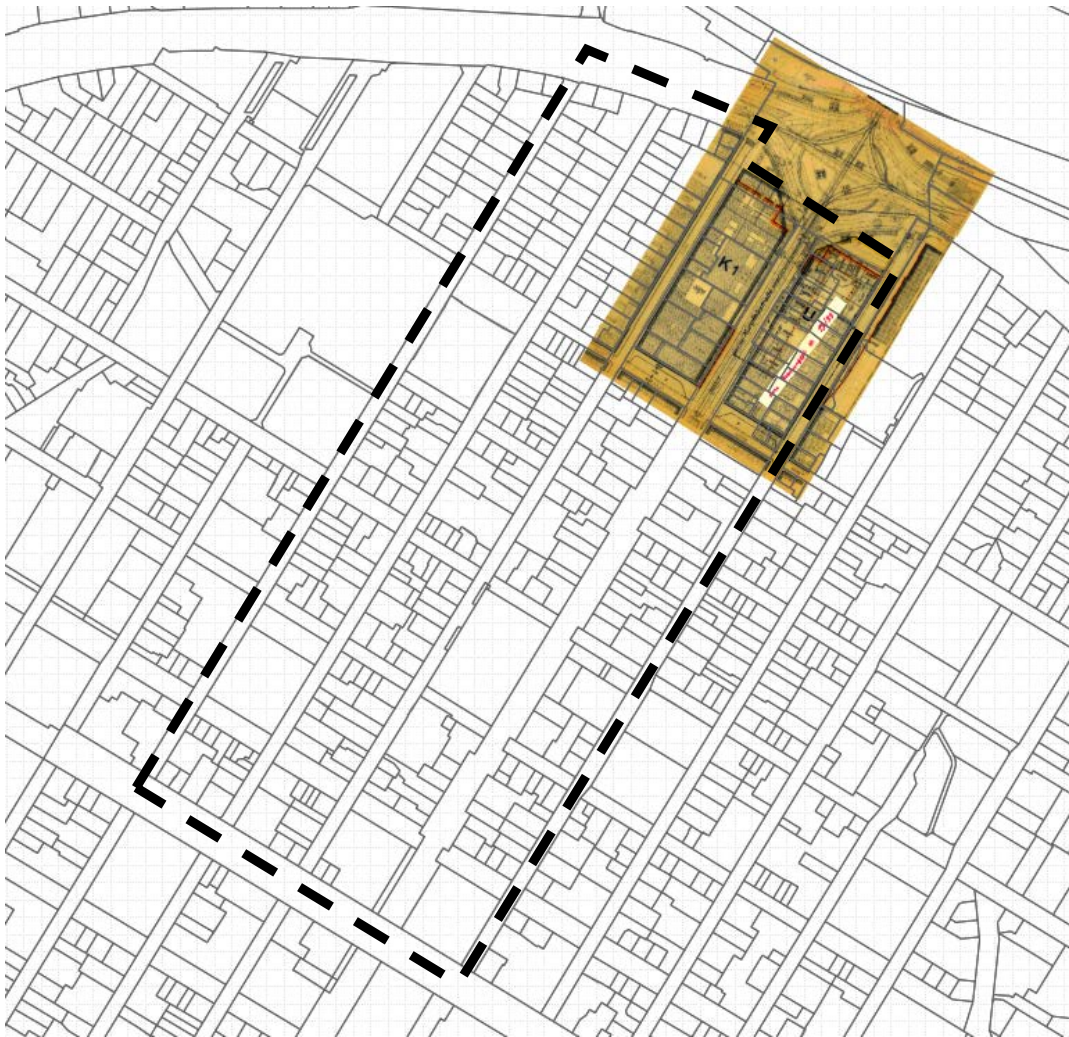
Bebauungsplan 13.20 in Überlagerung mit dem Geltungsbereich 11.43
